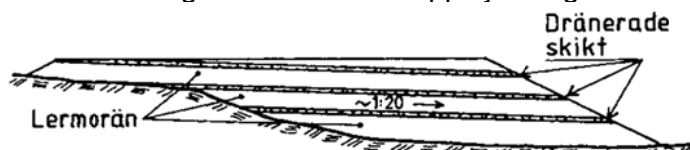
Minsta utsträckning av packad fyllning i plan och djup
